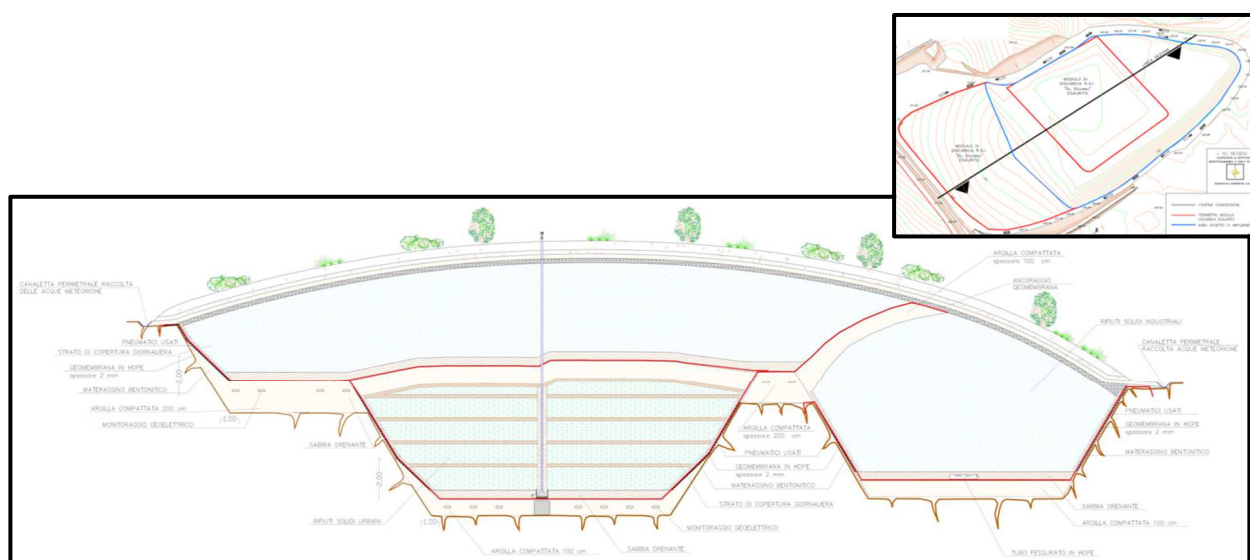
/II: Sezione-tipo modulo n. 6
